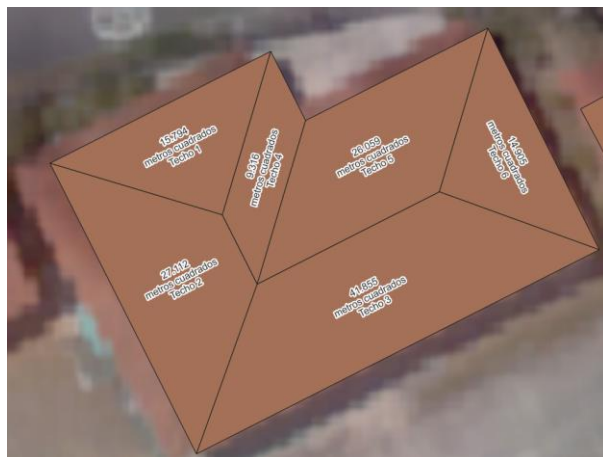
Área Plana techos Bloque Archivo de Gestión SRCA sede Armenia
